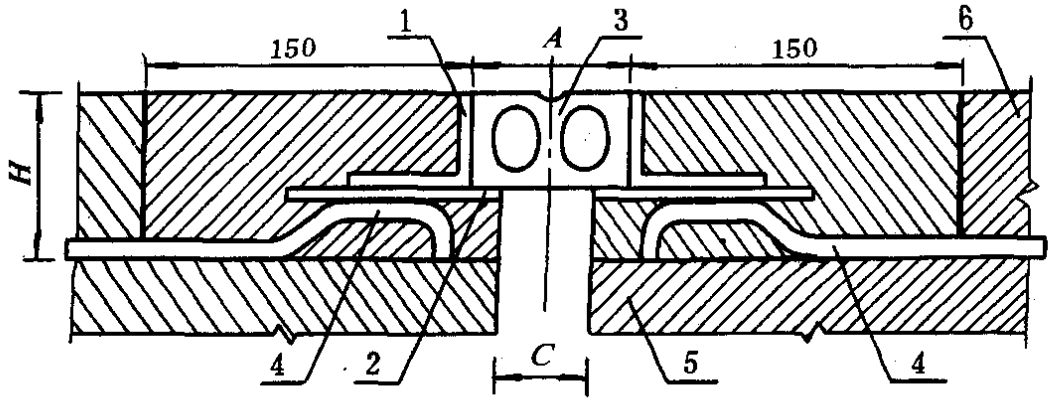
矩形橡胶条型伸缩装置构造示意图 (尺寸单位: mm)
